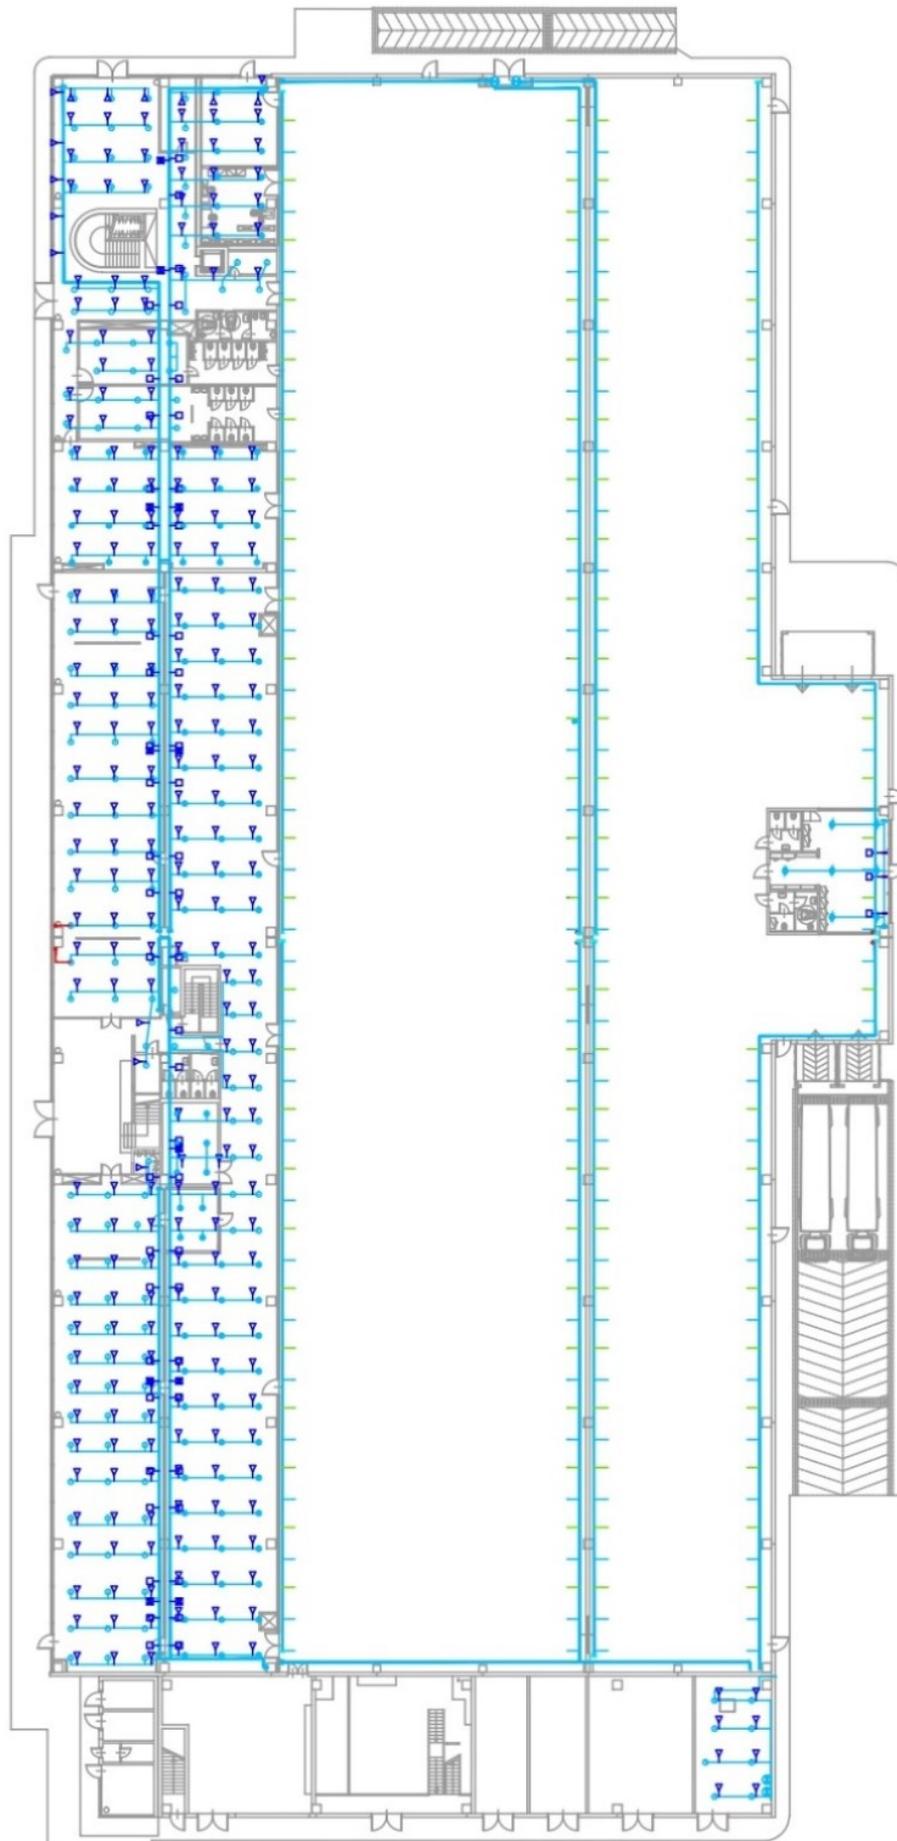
Planimetria sprinkler piano terra zona uffici
